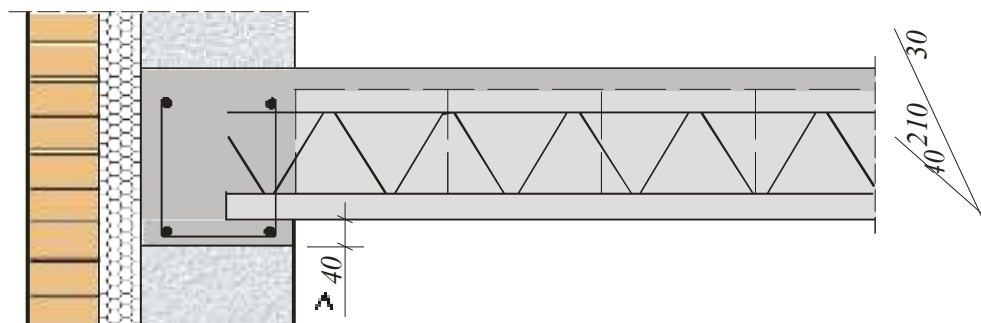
Венец укрепляющий перекрытие, запущенный на наружную стену.
